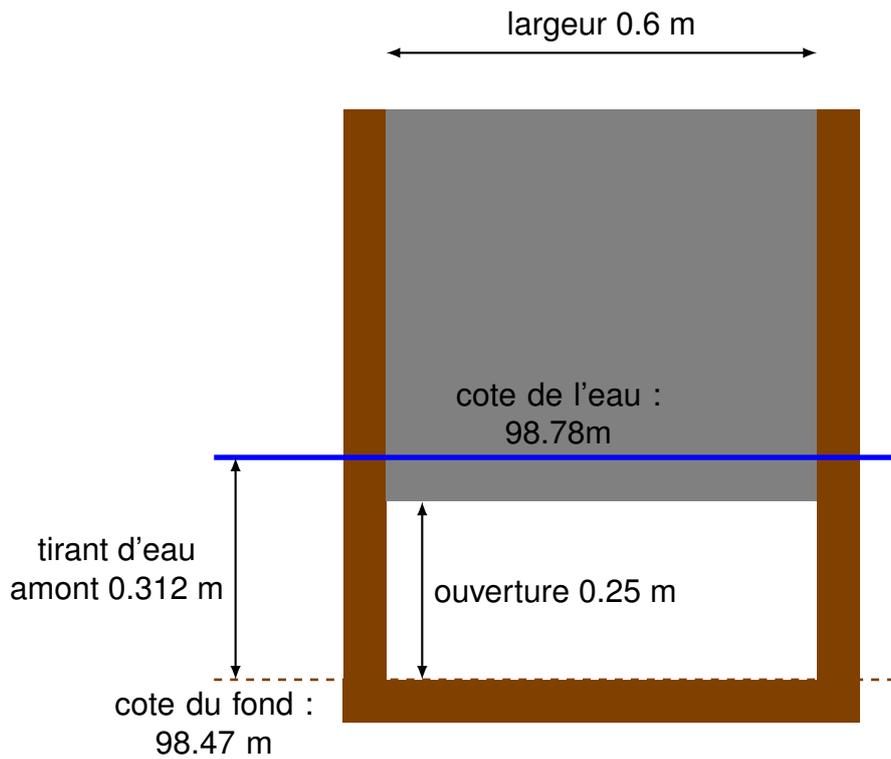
Coupe transversale de la vanne de la prise d'eau du canal rive gauche
